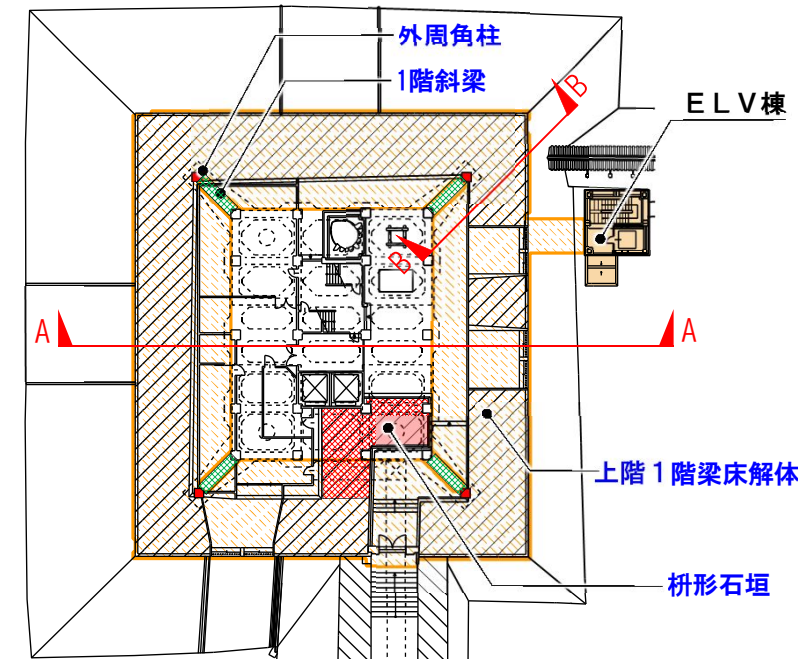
大天守解体部分地下平面図(ELV棟含)
